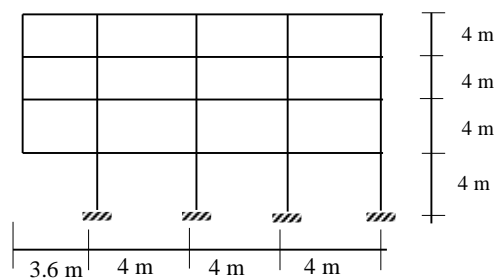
Tampak samping struktur bangunan Dengan panjang tonjolan 15%
